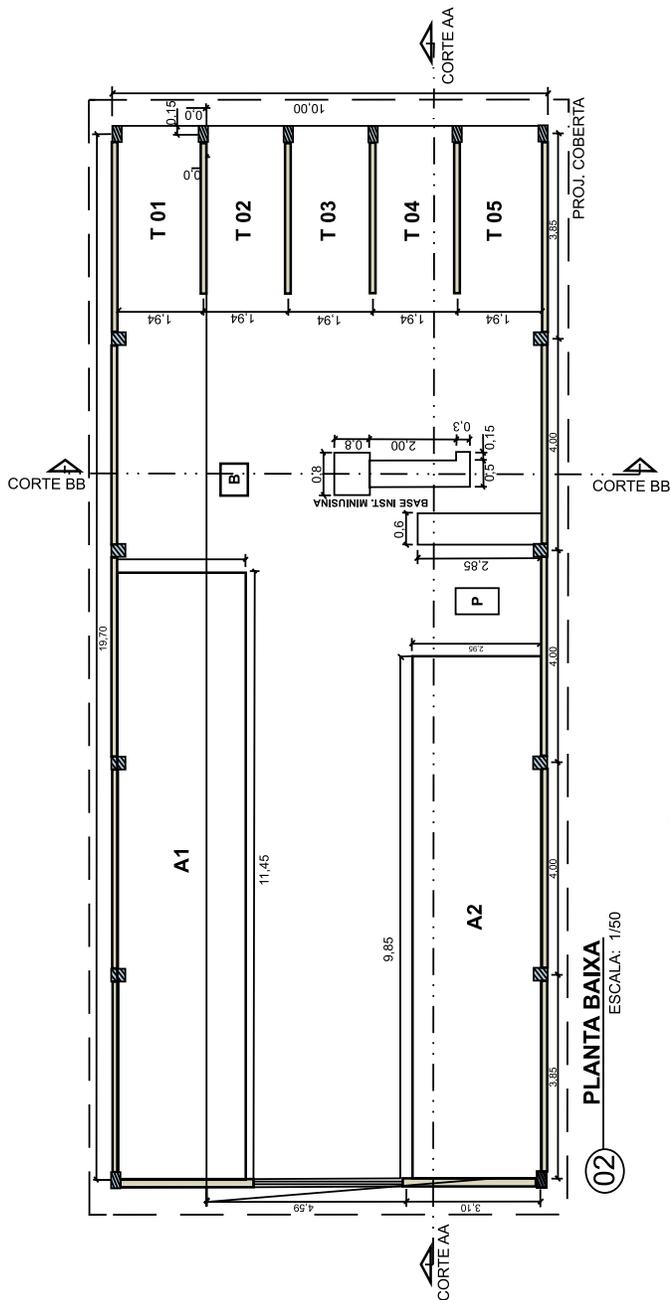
Planta baixa da agroindústria de algodão em pluma, (em metros).
